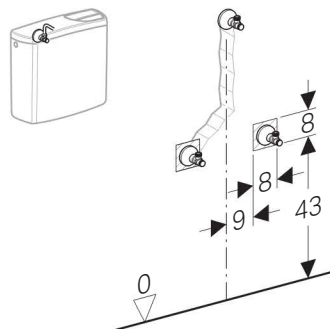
Massbereich Wasseranschluss verdeckt, Bauhöhe 101 / 114 cm
